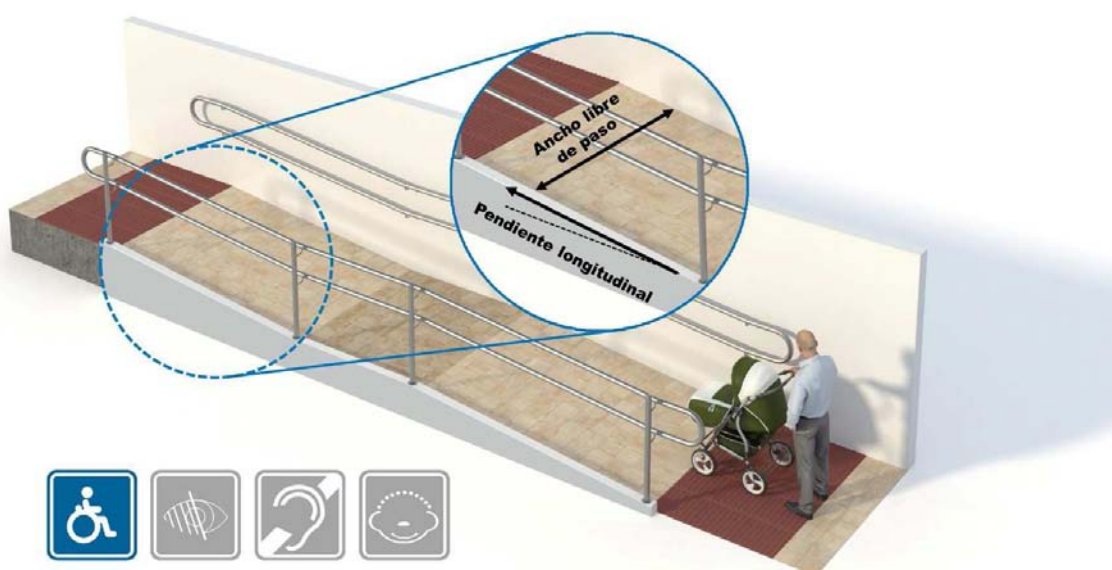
Detalles de diseño. Pendiente y ancho útil de paso
